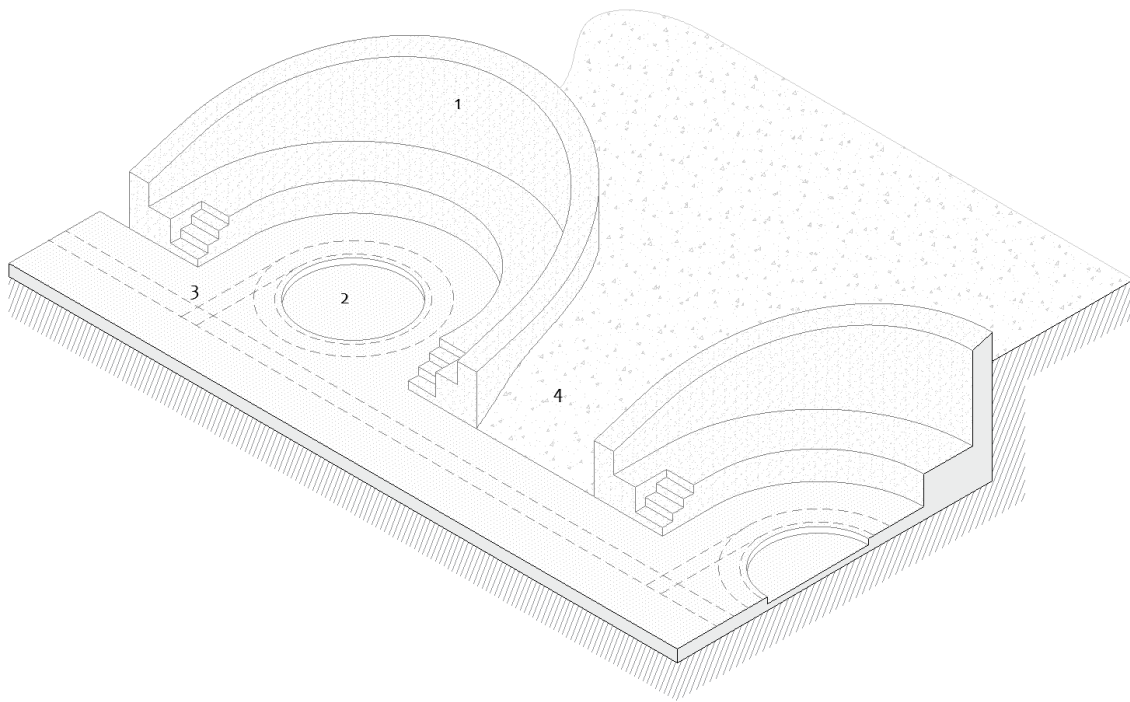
Axonometría seccionada de las barbetas donde se artillan los obuses Ordoñez 24/16 cm: 1. Muro de contención de hormigón, 2. Barbeta, 3. Sistema de railes, 4. Terreno en pendiente. (Dibujo propio)
